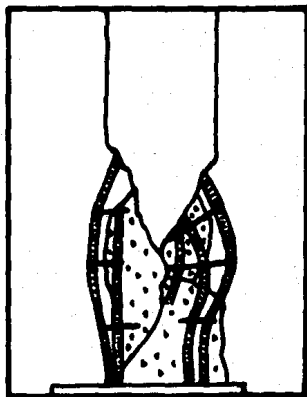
(3) Falla de Columna por cortante y fuerza axial
